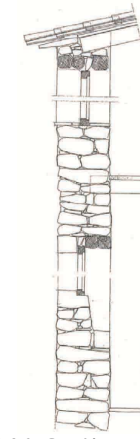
Sección por el muro de mampostería. Según Miguel Ángel Charri. 9.4.2
